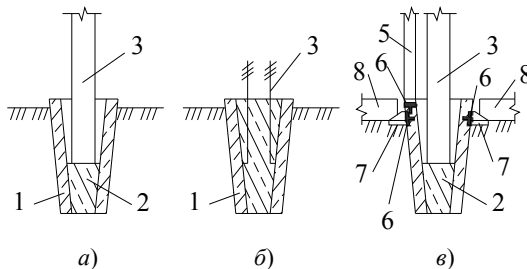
Способы сопряжений конструкций зданий и сооружений с фундаментами из забивных блоков:
